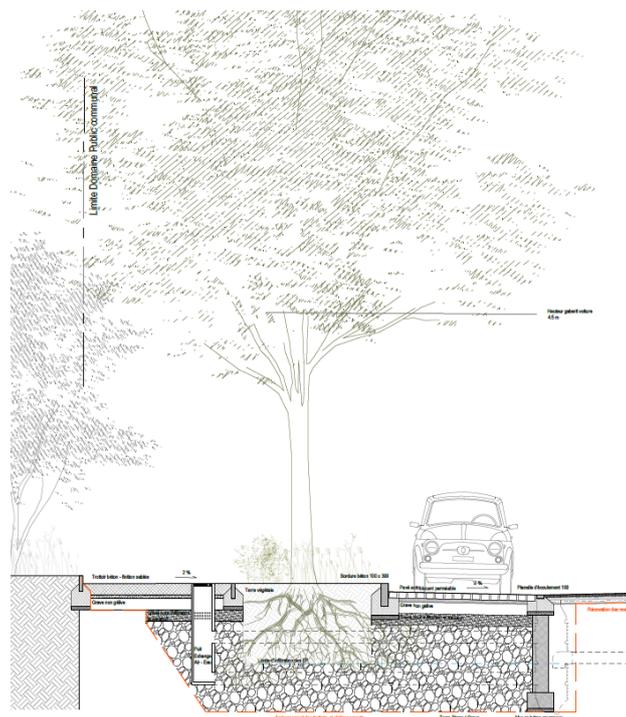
Fosse de plantation en terre pierre sous les stationnements (coupe)
